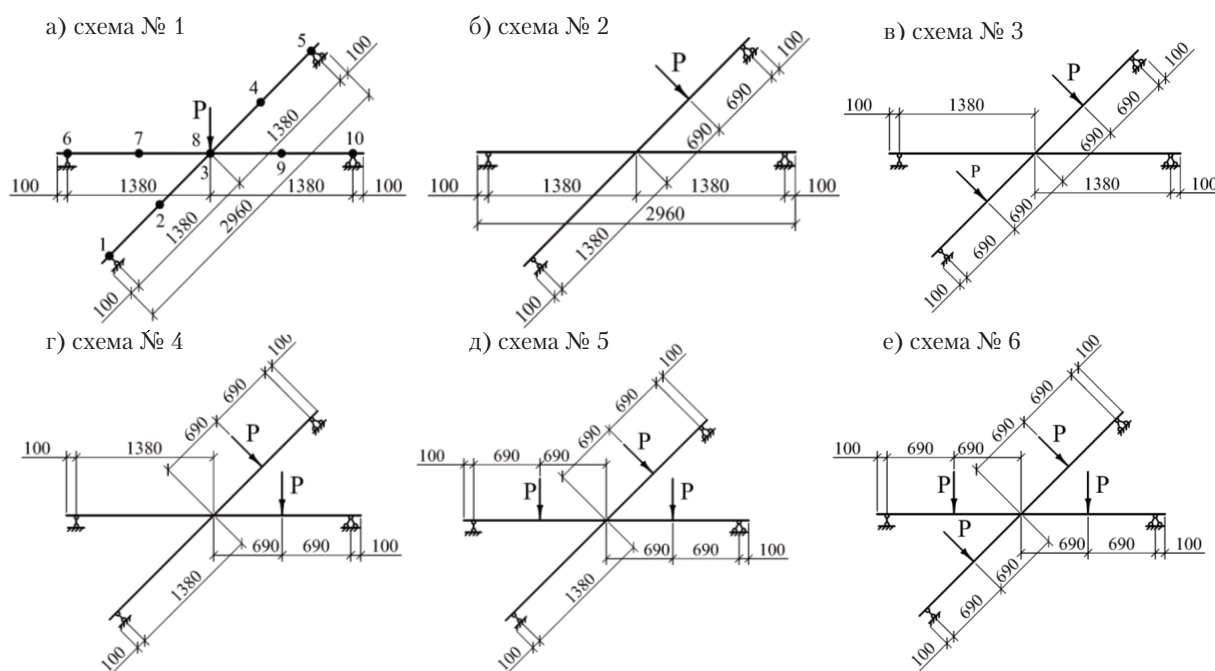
Схемы передачи нагрузки на испытываемый узел
